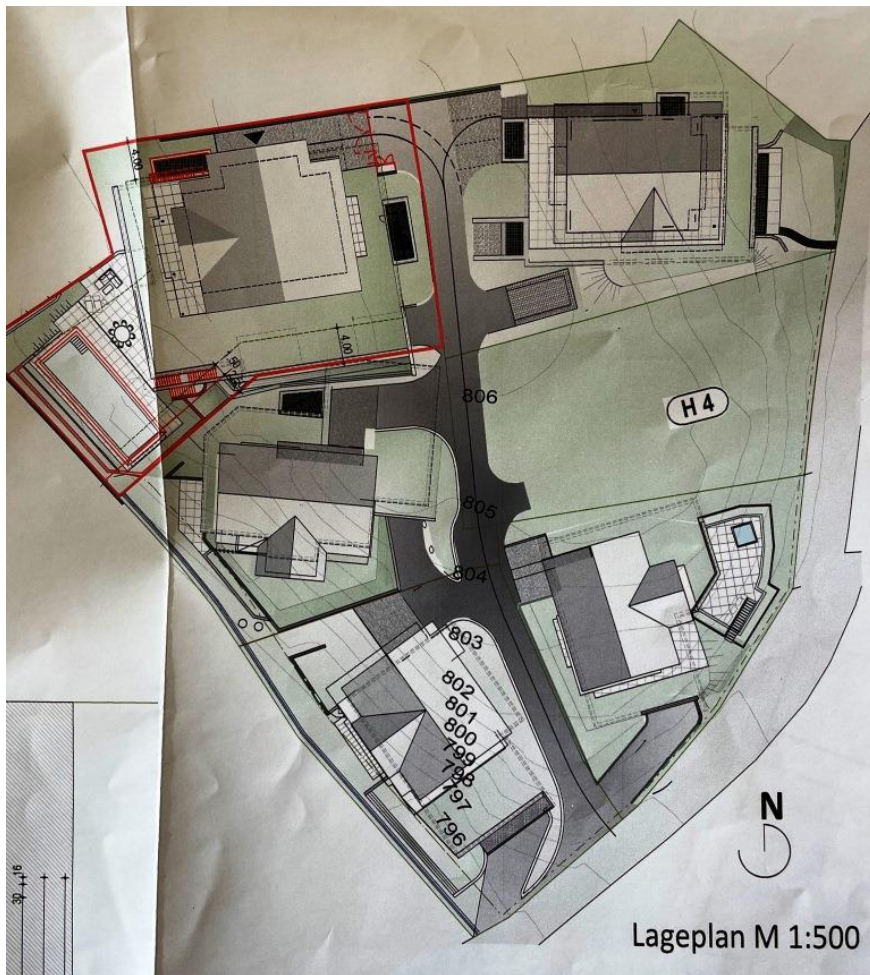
Lageplan inkl. Lage der Privatstraße; Quelle: Änderungsplanung v. 31.05.2022
